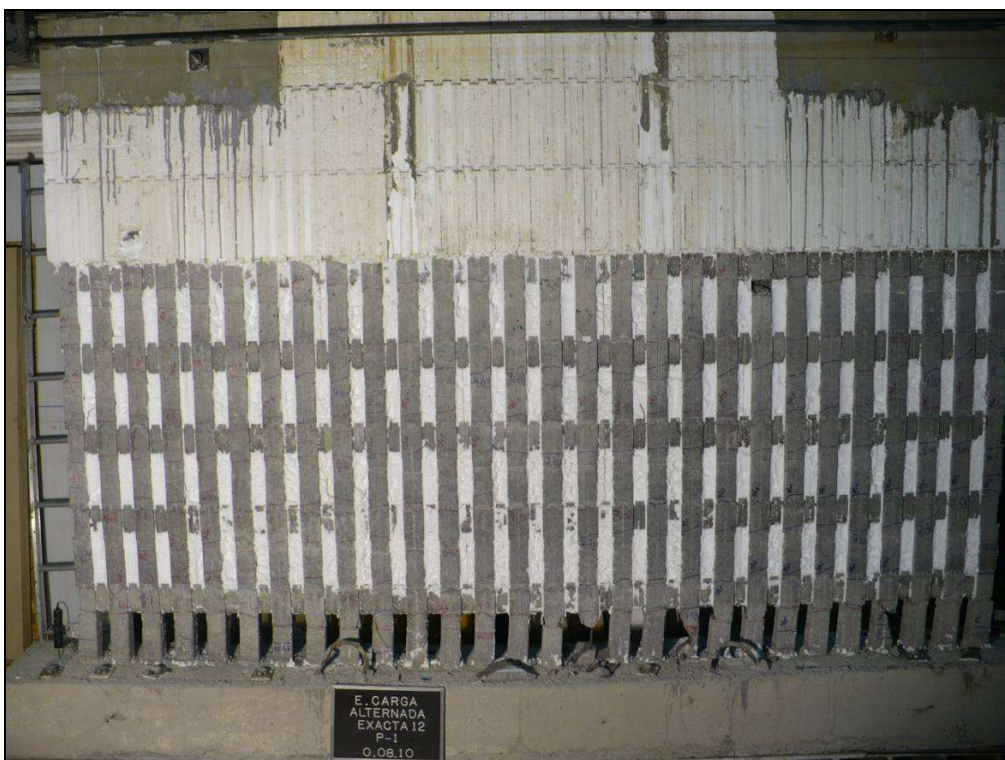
Nivel de daños del muro 1 para el estado límite "*Estado Final*".
